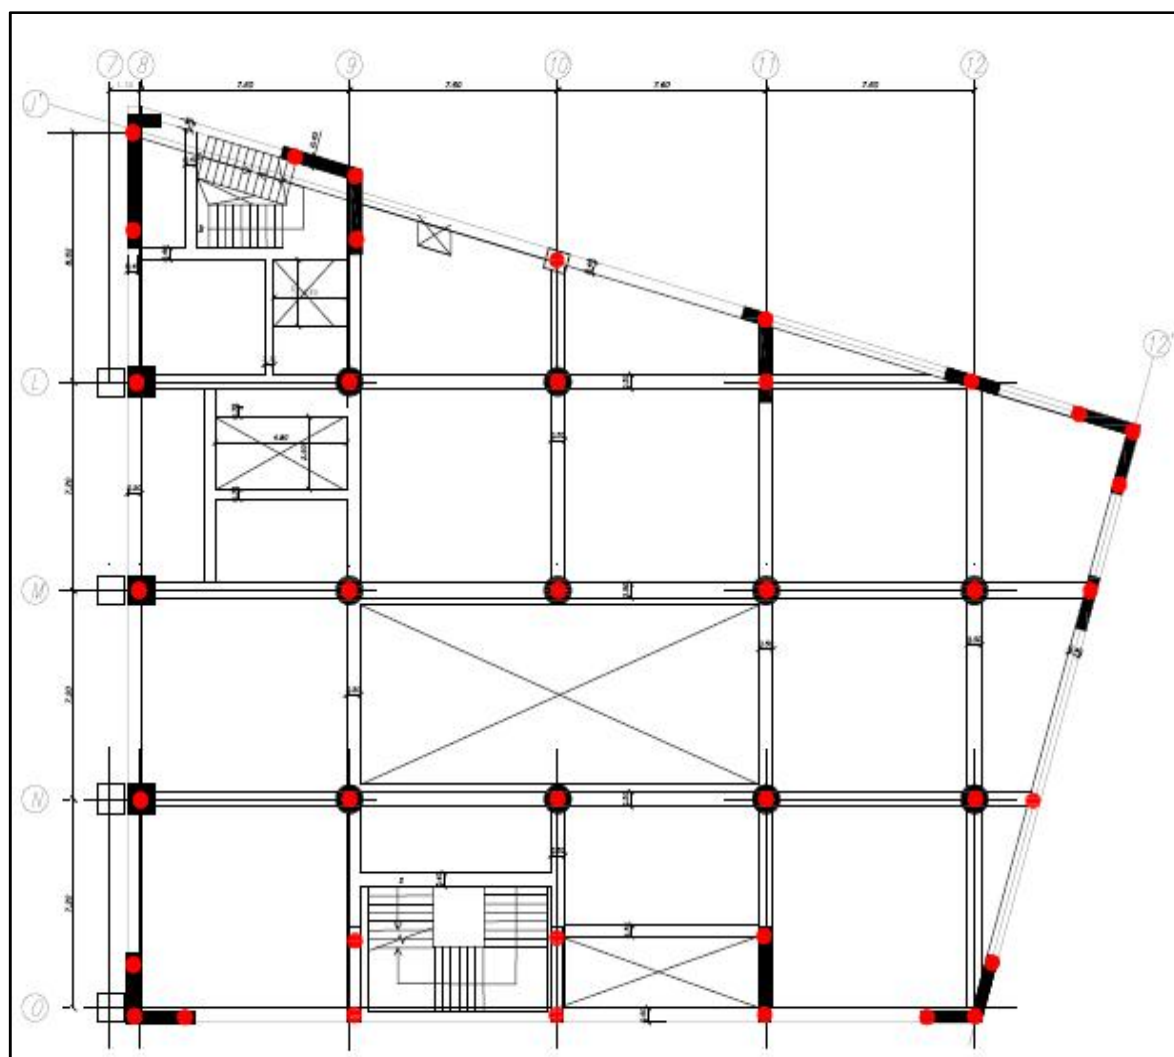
Ubicación de aisladores HDR, Hall Central
